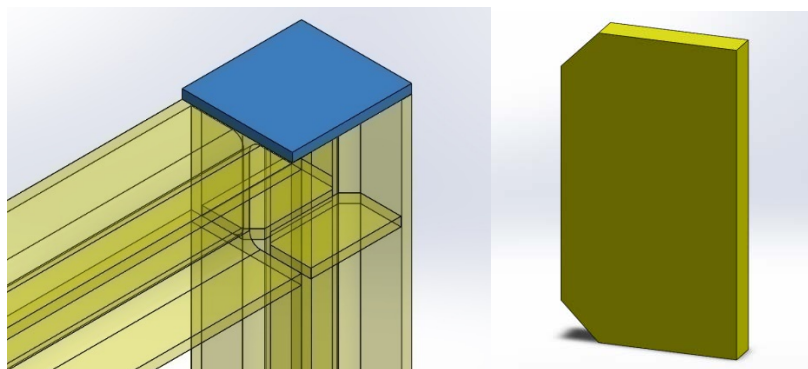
Tapa 120x130x10mm y nervio de refuerzo para perfil HEB120
